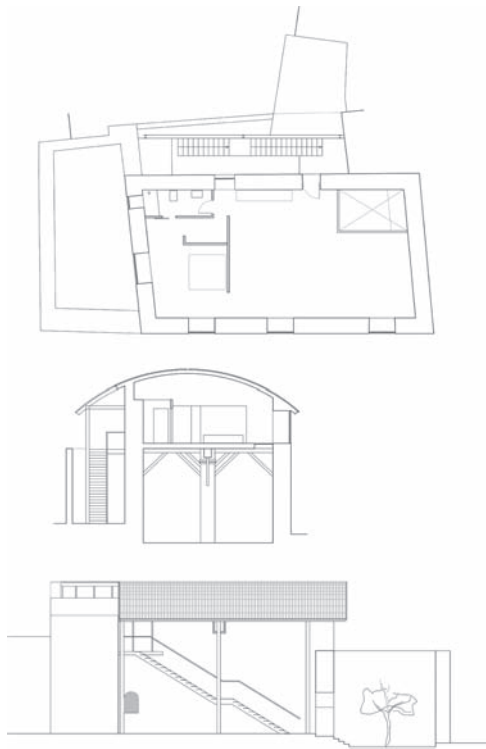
Planos de proyecto: planta de la vivienda, sección transversal y alzado al patio lateral de acceso a la vivienda.
